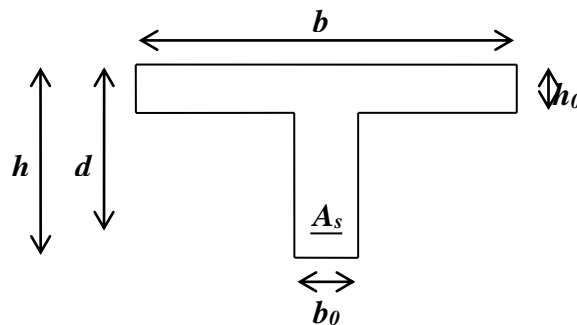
Schéma représentatif des dimensions de la poutrelle
